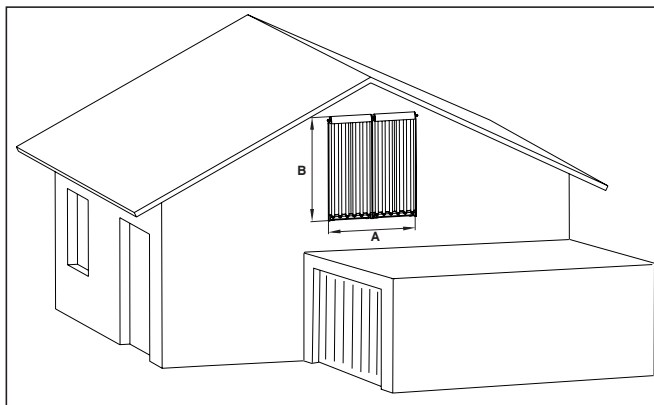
Wichtige Maße bei Fassadenmontage
